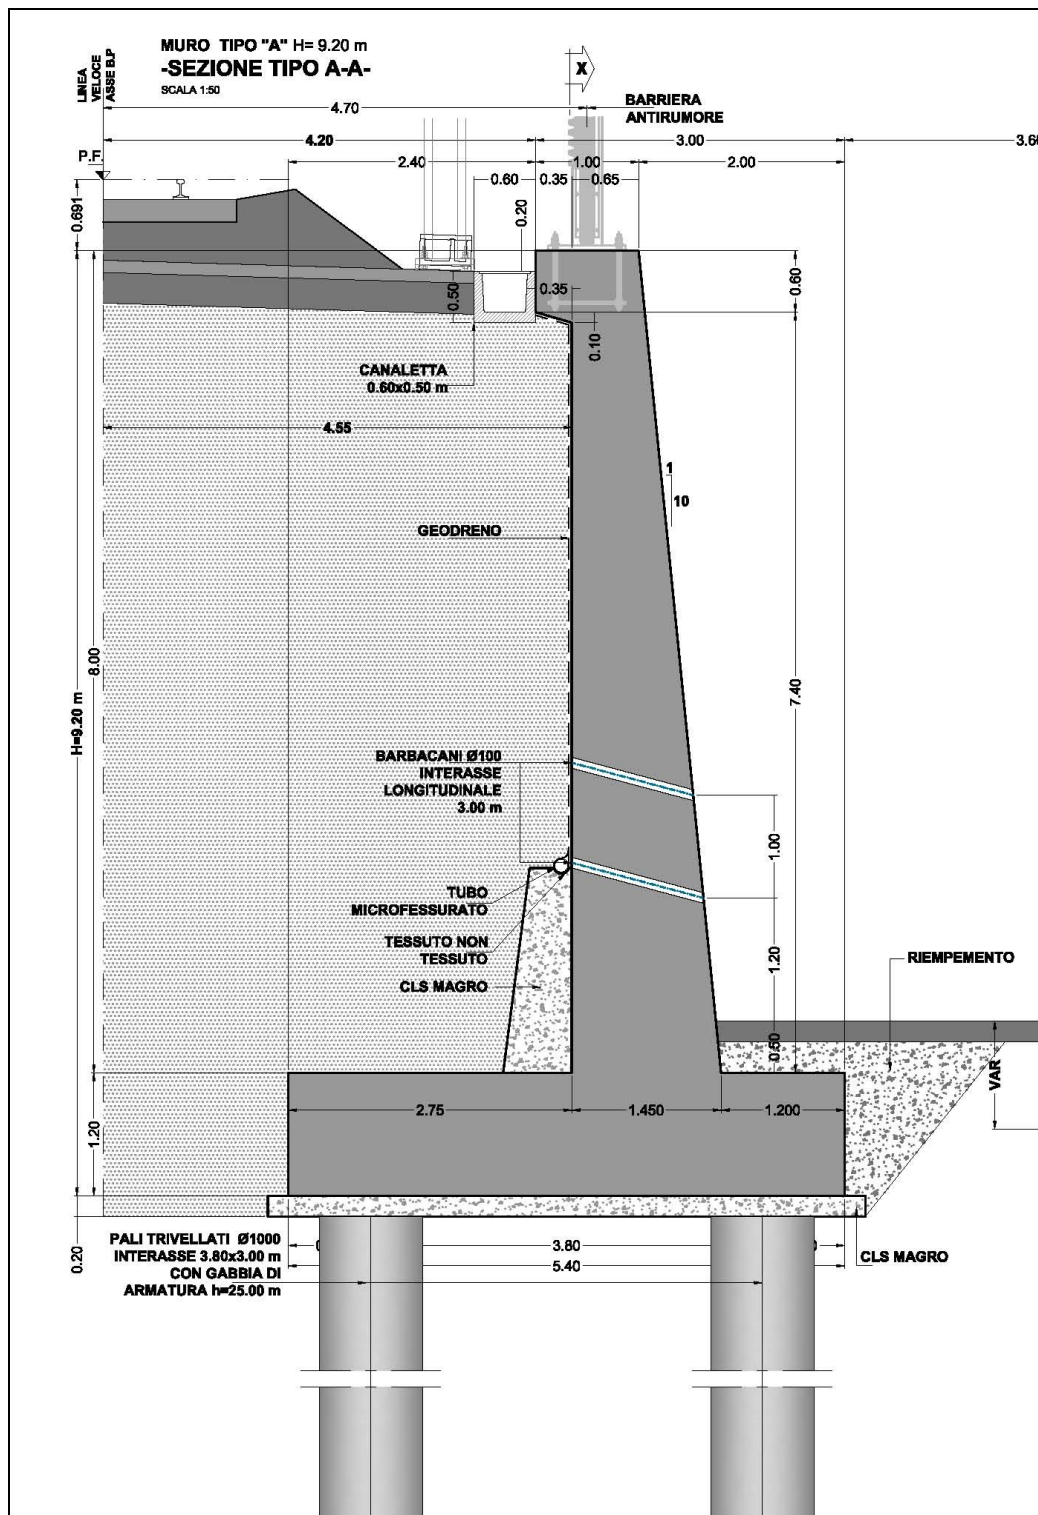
sezione di carpenteria del muro (altezza paramento= 8.00 m)
